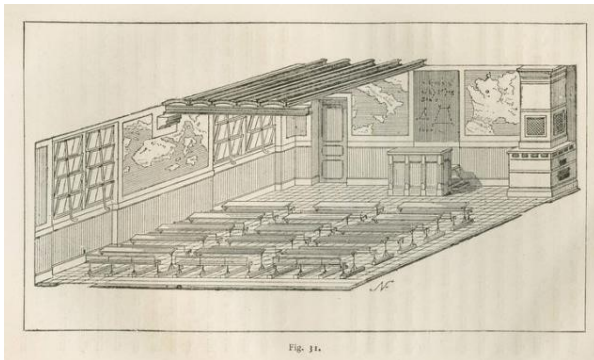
Les écoles publiques en France, Construction et installation, Félix Narjoux, 1877
